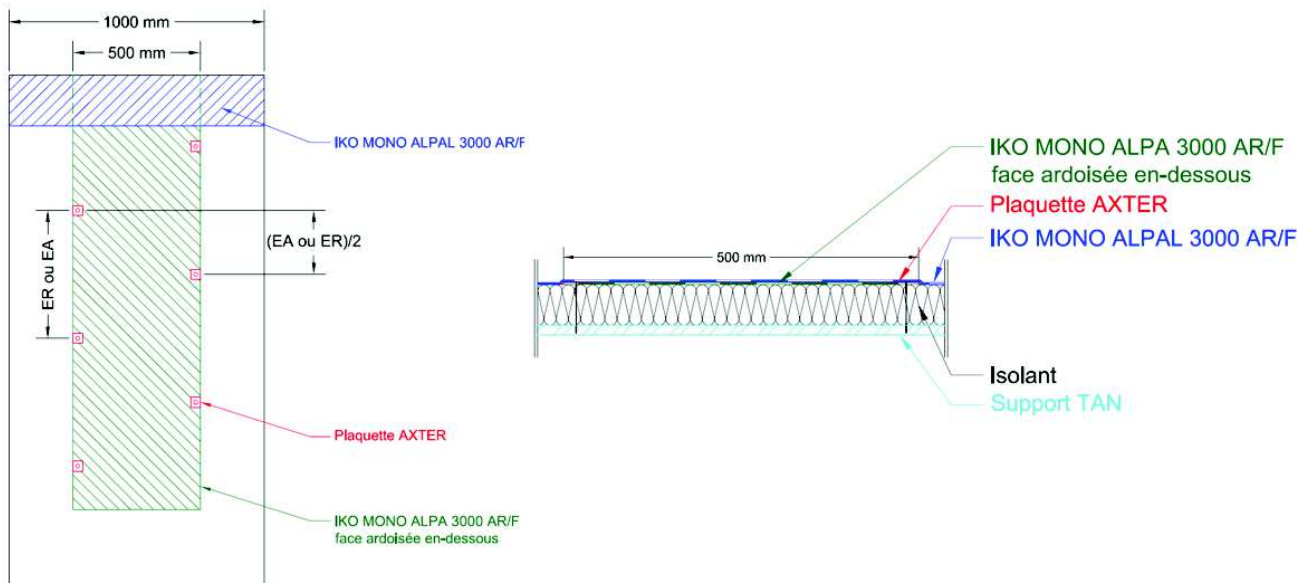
Fixations complémentaires éventuelles sur bande de renfort – soudure au chalumeau sur PIR
